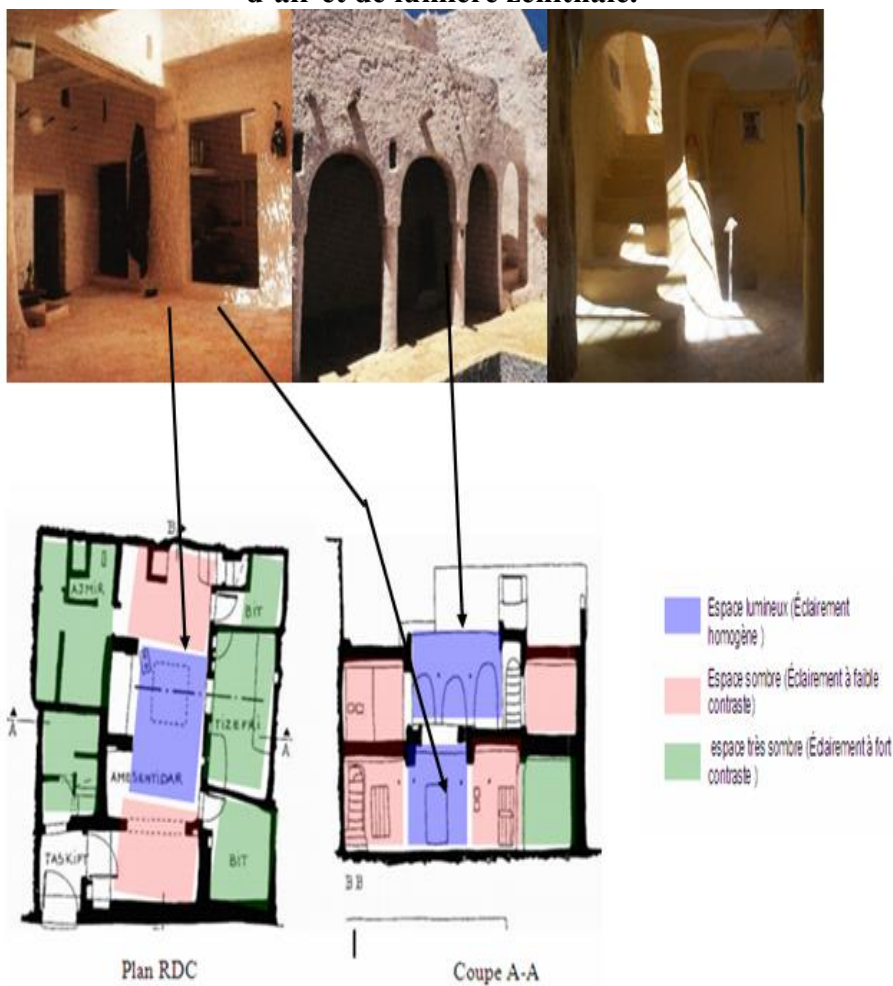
Plan et coupe d'une maison traditionnelle (source: Bousquet C., 1986)
